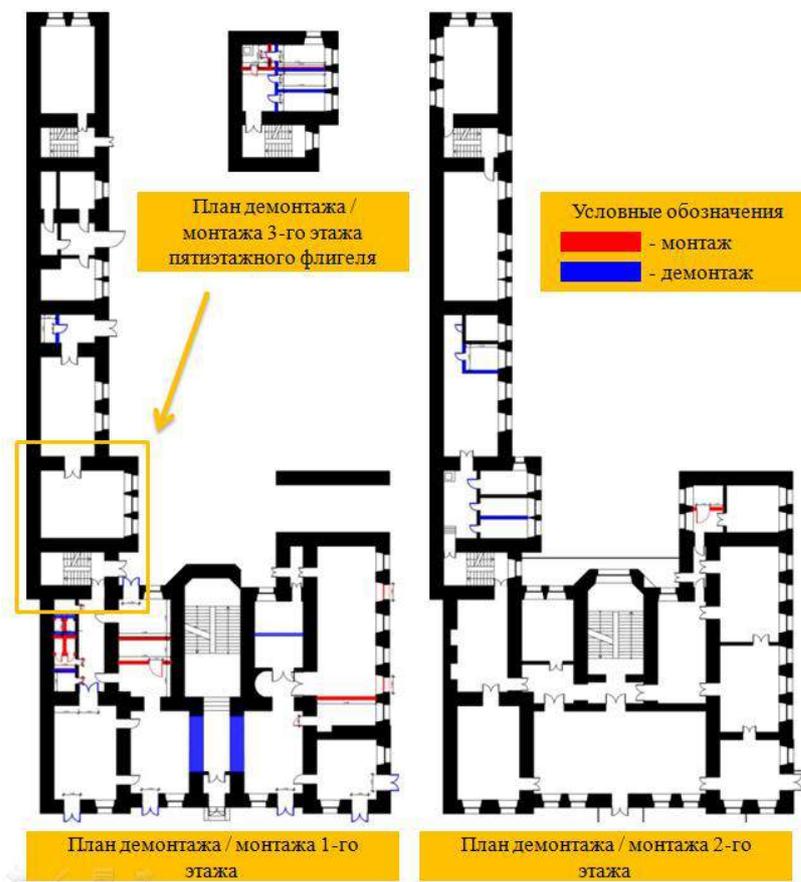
План демонтажа и монтажа 1-го, 2-го этажей и 3-го этажа 5-ти этажного флигеля усадьбы А. И. Губина.
